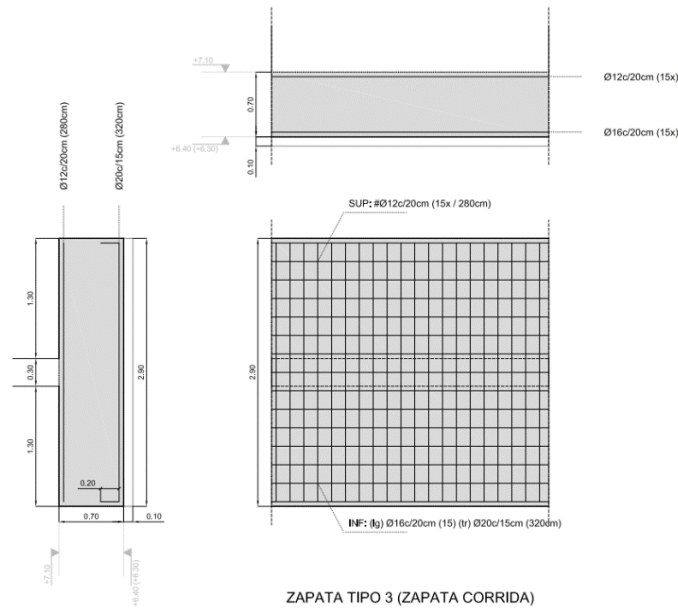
Armado zapata tipo 03. Fuente: David Gallardo.
